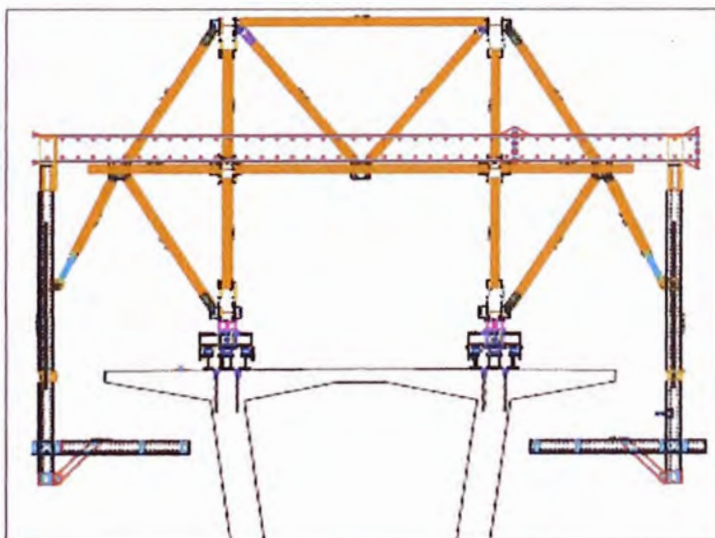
Vista sección de montaje de Viga 240 suspendida.
